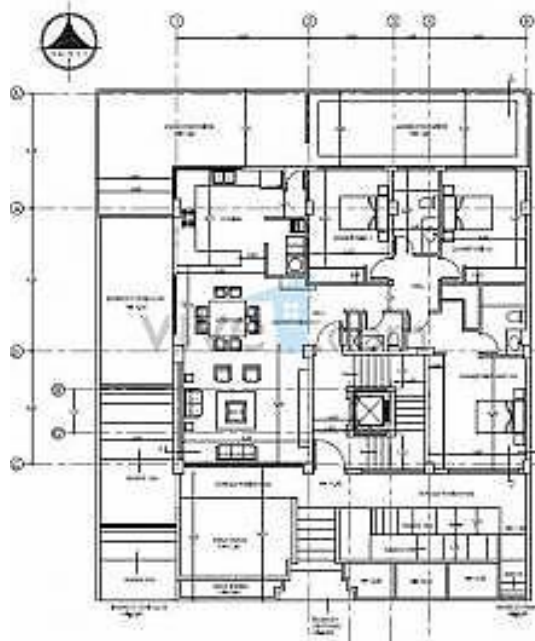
PLANO DEL PROYECTO JOHANA.
